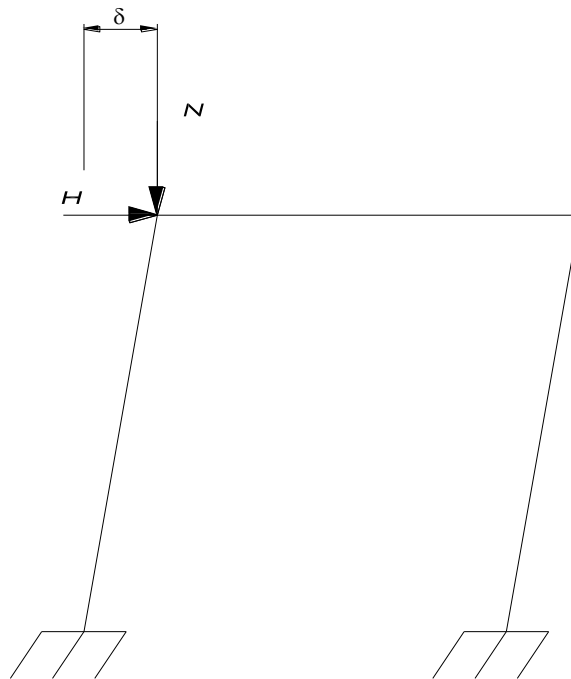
Pórtico plano deformado sob ação do carregamento horizontal
